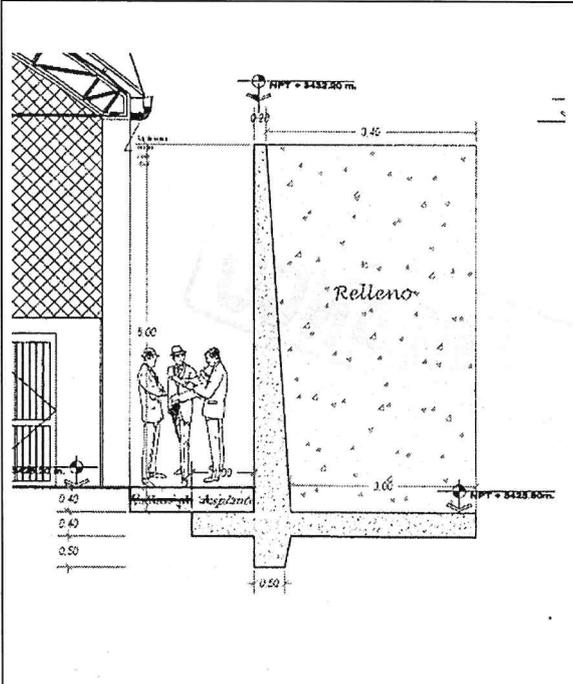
En el plano lamina A-06 Elevación lateral-muro de contención y cancha; no se visualiza los detalles de la tubería de drenaje ni sub dren.
